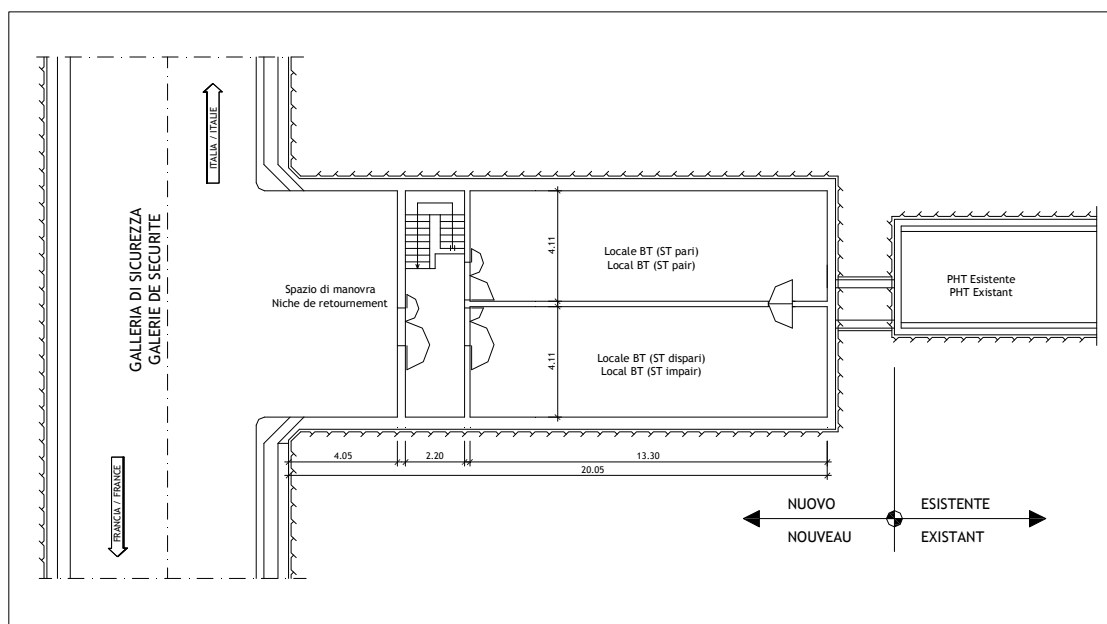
Stazione tecnica tipo - Pianta piano primo
